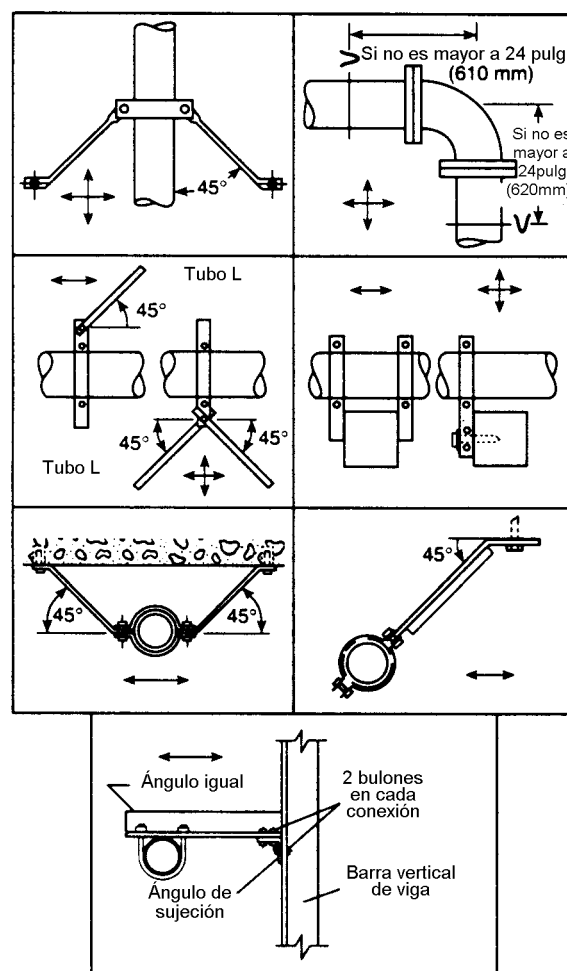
(f) Tipos aceptables de arriostamiento contra vibraciones.
